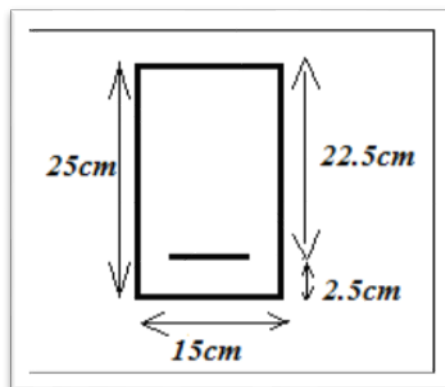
Section théorique pour le ferrailage du plancher (sur appui)
